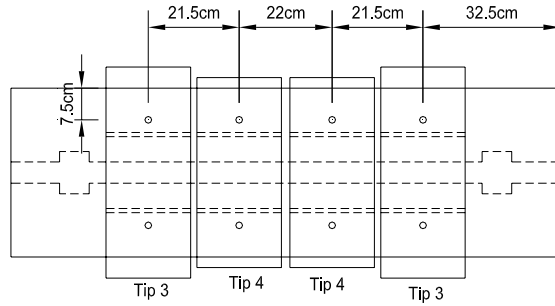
Betonarme çerçeve taban bağlantı tablası detayları
